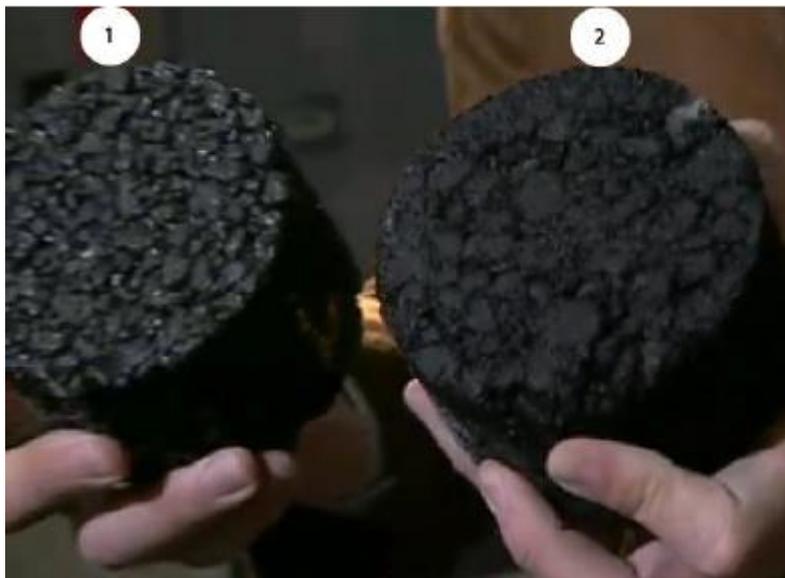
Pavimento de Asfalto Convencional e Pavimento de Asfalto Poroso (G1 GLOBO, 2010, *online* min 04:45).
